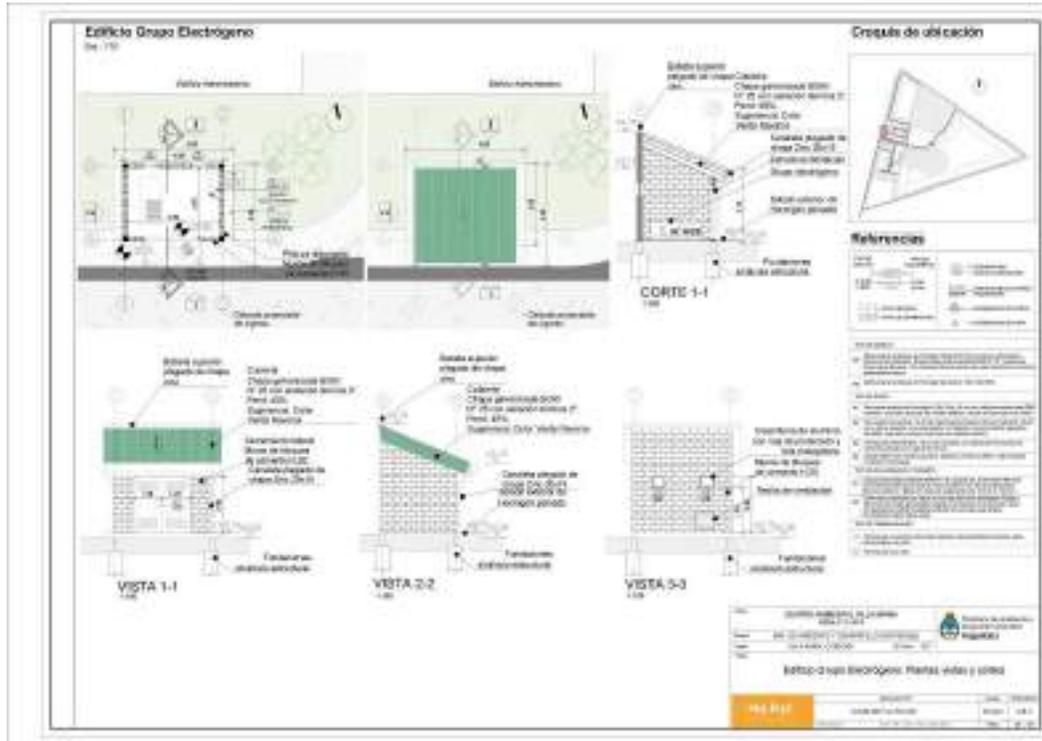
Villa María. Edificio del grupo eléctrico. Arquitectura de planta.
